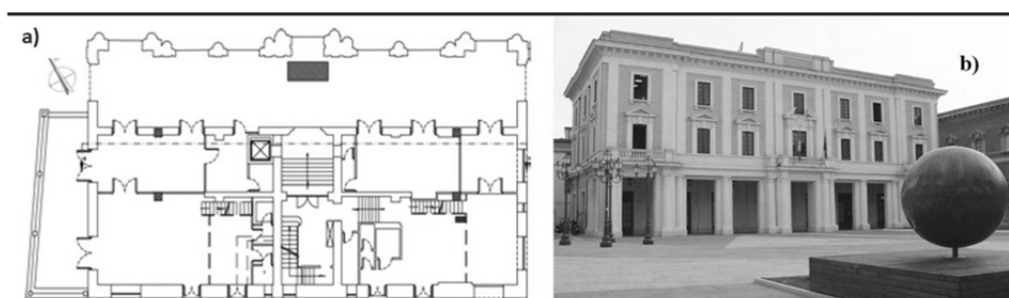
a) pianta del piano tipo; b) facciata principale dell'edificio (Piazza Roma)
